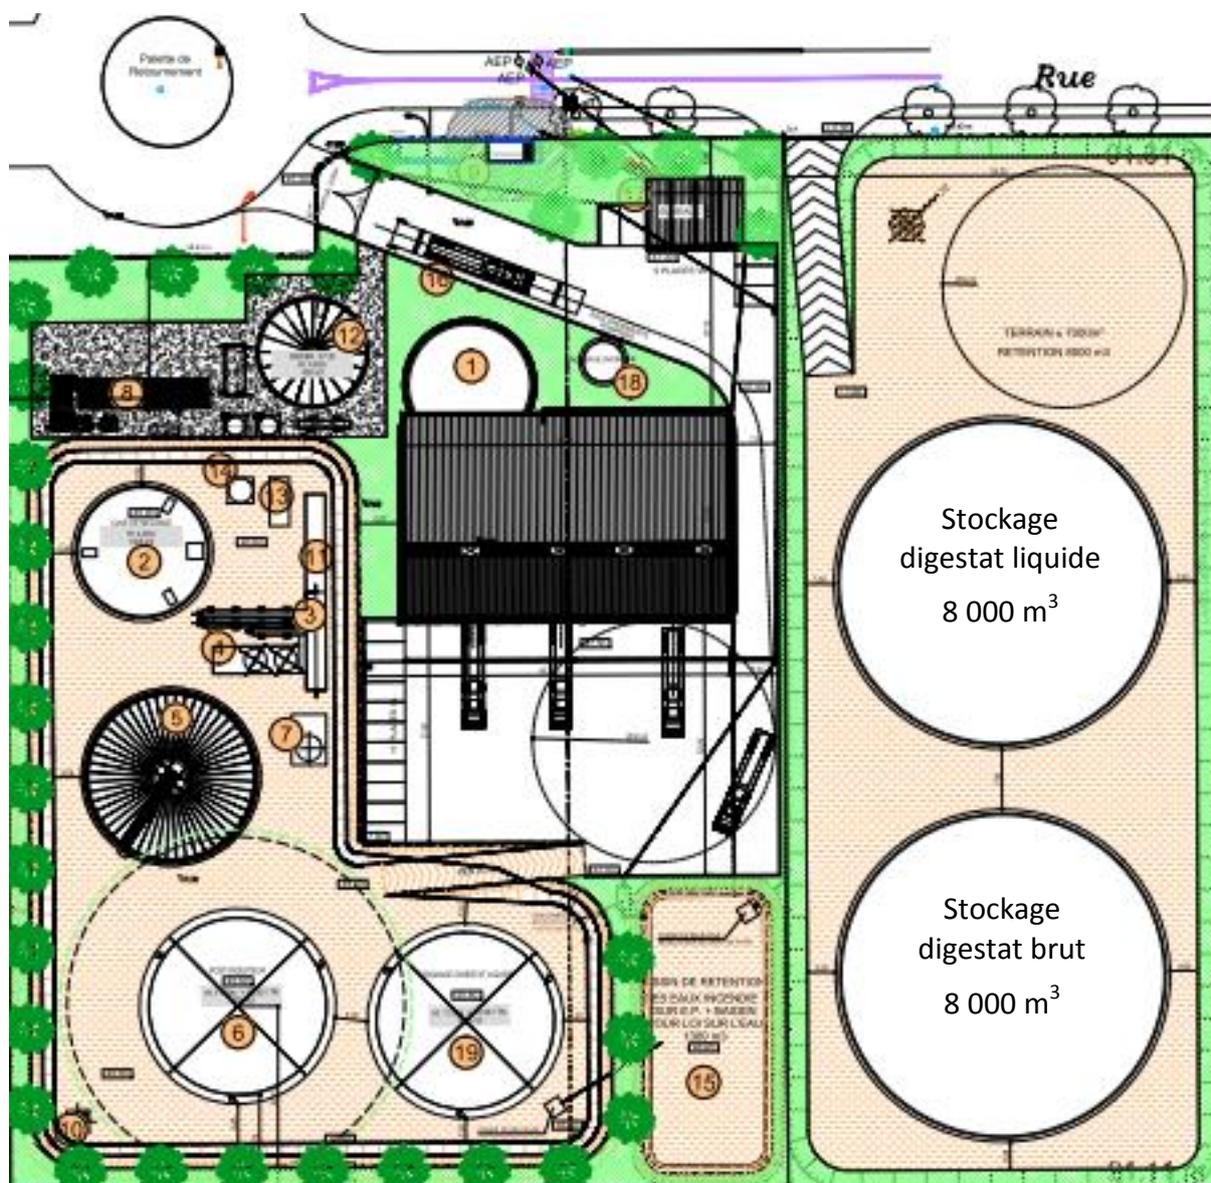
Plan d'implantation de l'installation BIOROUSSILLON
